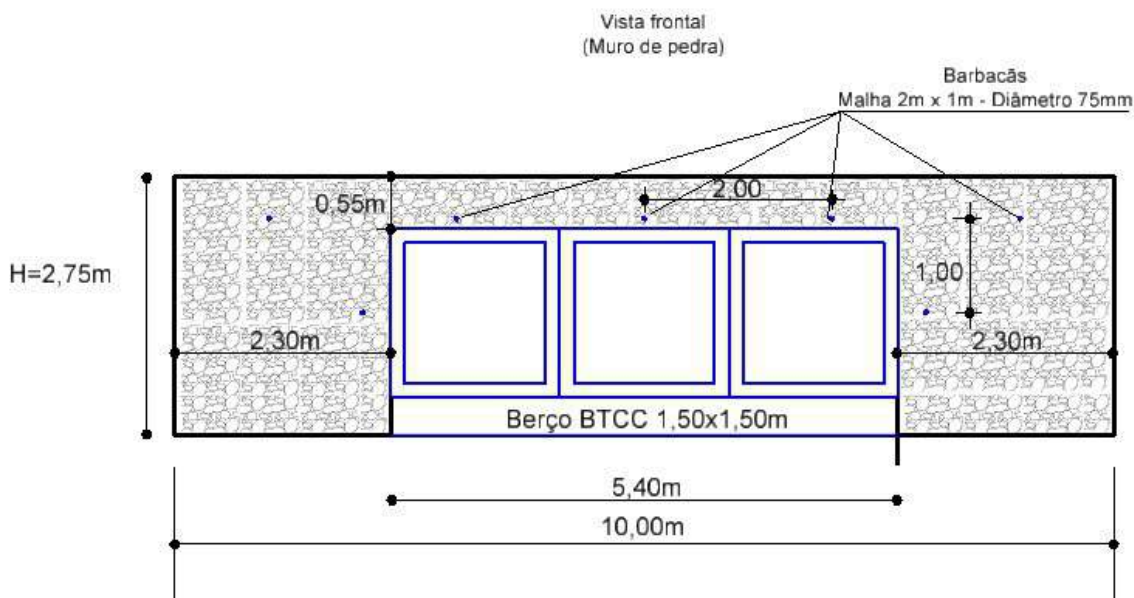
Vista frontal do muro de pedra projetado na Avenida das Mangueiras
